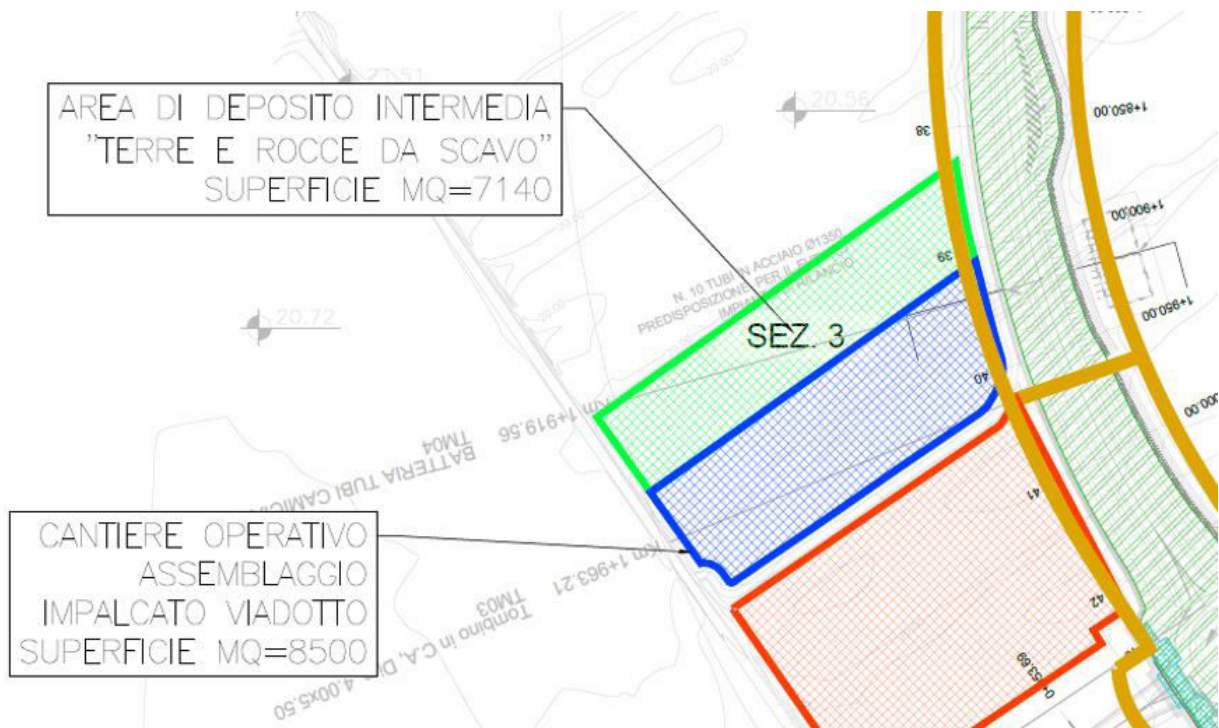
Localizzazione area di cantiere deposito intermedio - CO02
